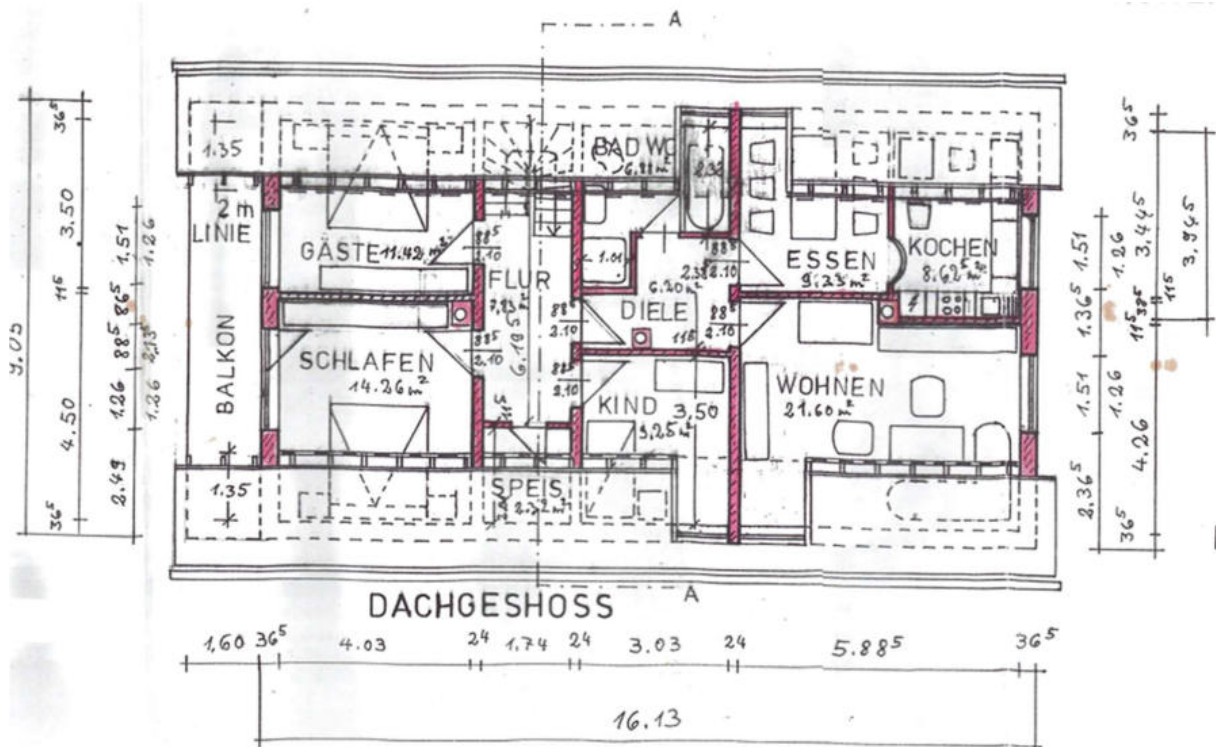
Grundriss Dachgeschoss (Aufstockung 1997)
